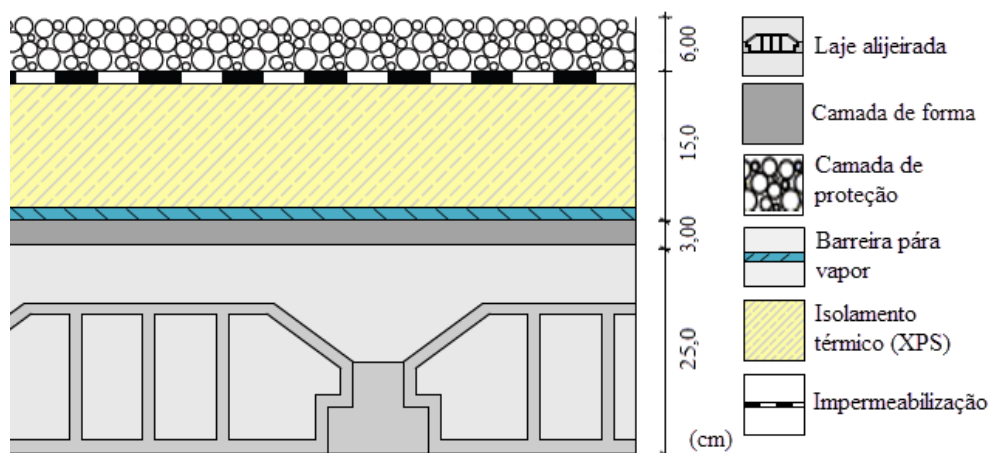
Solução construtiva de laje de cobertura plana – não acessível
